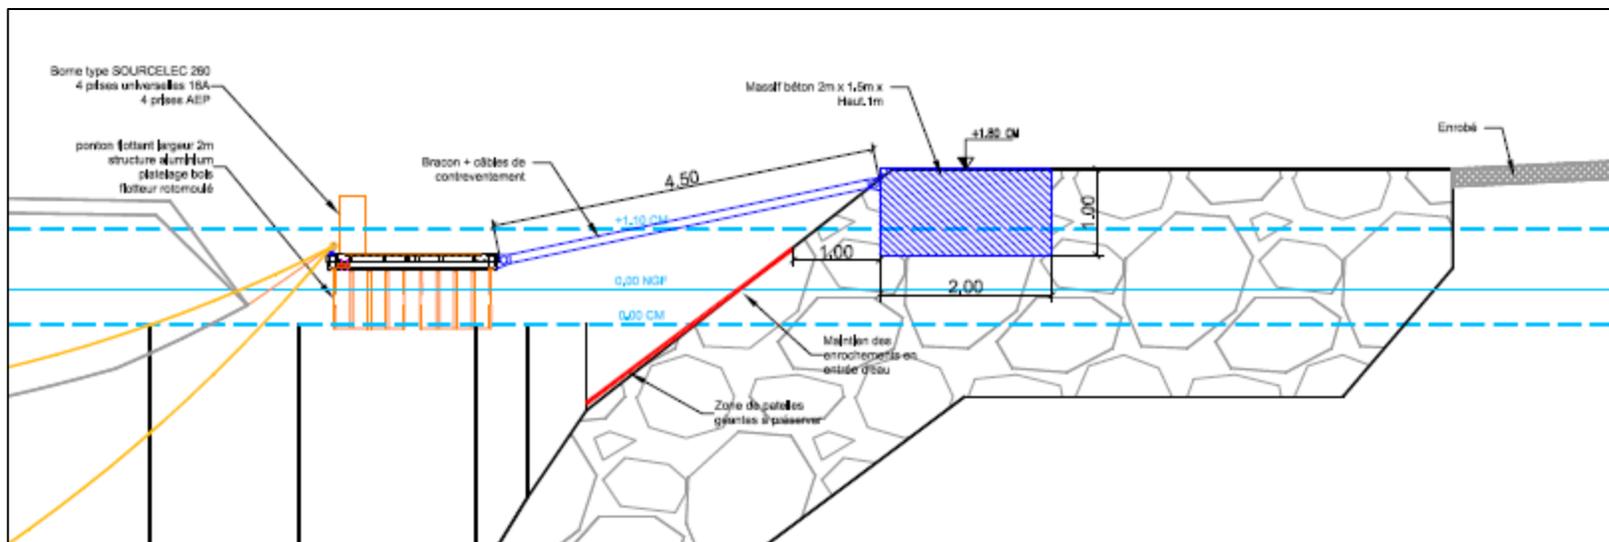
Coupe de principe sur massif béton bracon Etat existant – ICTP 2020
